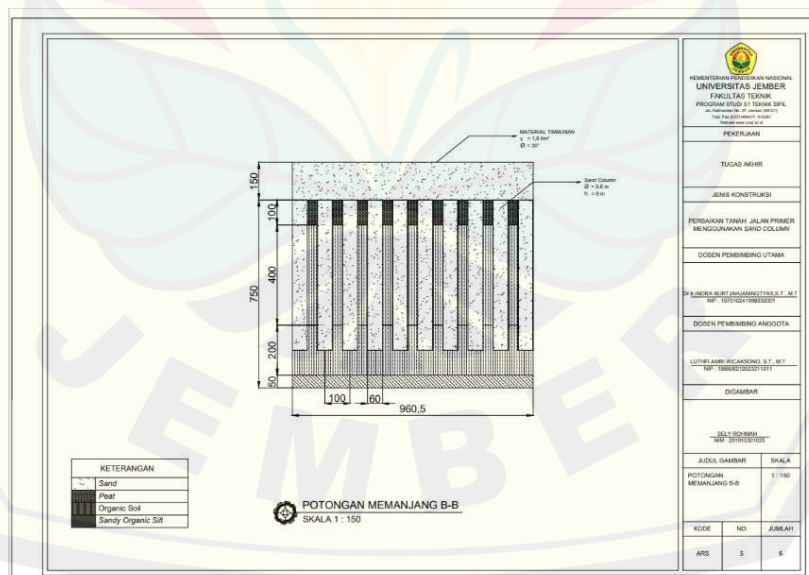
merupakan gambar potongan denah jalan primer yang menjadi lokasi perencanaan perbaikan *sand column*. Pada gambar ini terlihat bahwa jalan
